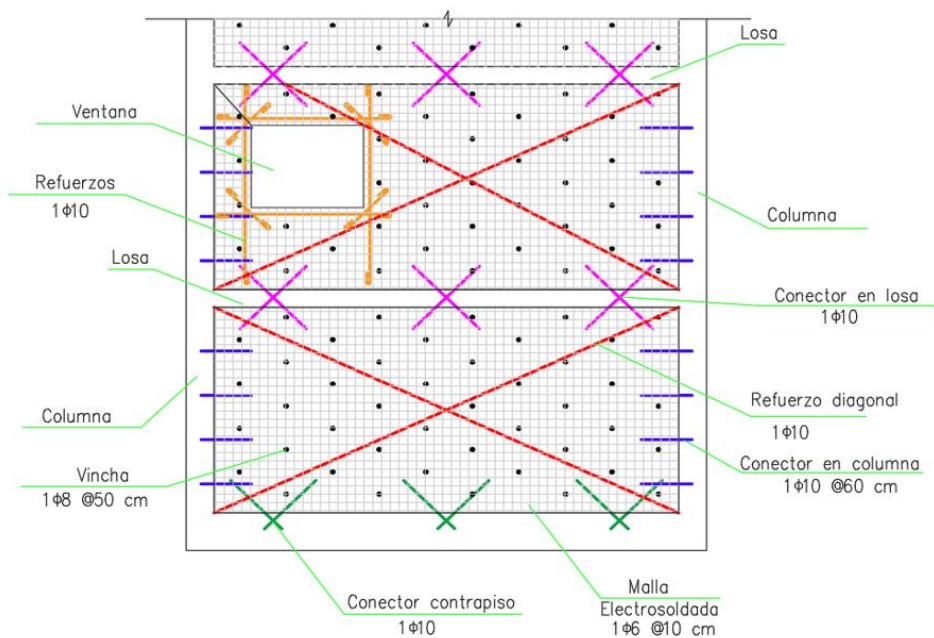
Detalle de enchape en mampostería con y sin aberturas. Fuente: los autores
